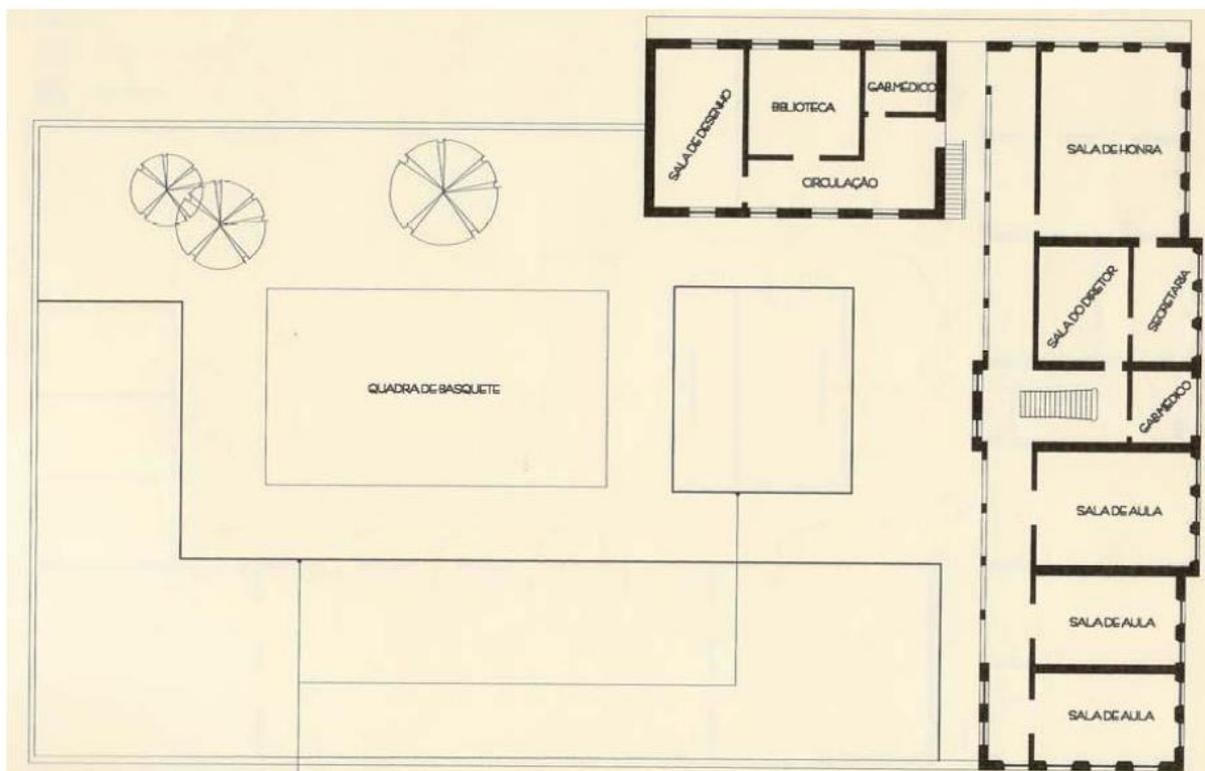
Planta baixa do pavimento térreo da Escola Industrial de Natal, 1940
